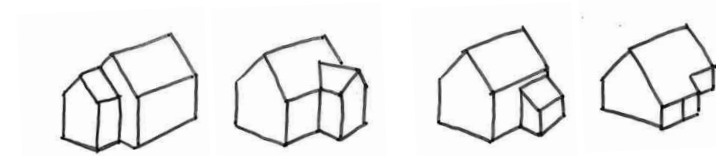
Mögliche Anbauformen (schlichte klare Baukörper aus einer rechteckigen Grundform). Neue Baukörper sollten sich in ihrer Formensprache an der umgebenden Bebauung orientieren. Unnötige Vor- und Rücksprünge sollten vermieden werden
